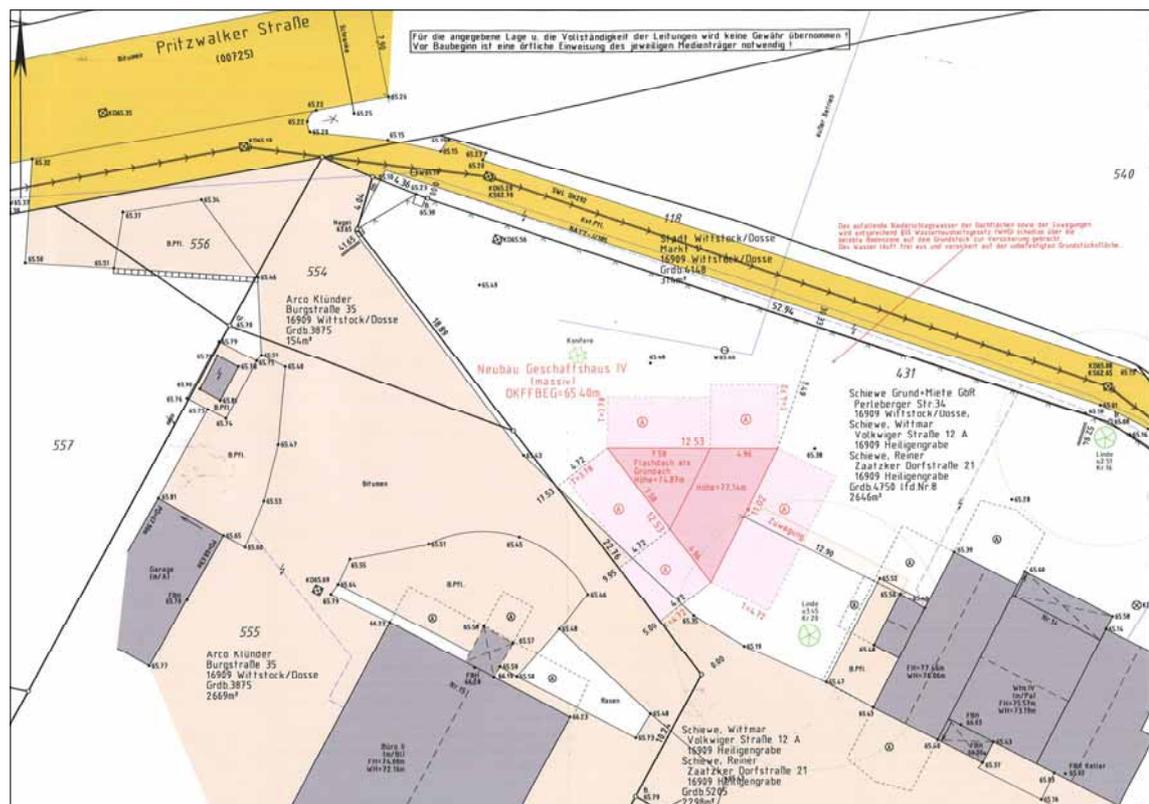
Lageplan Geschäftshaus Schiewe Grund+Miete GbR
